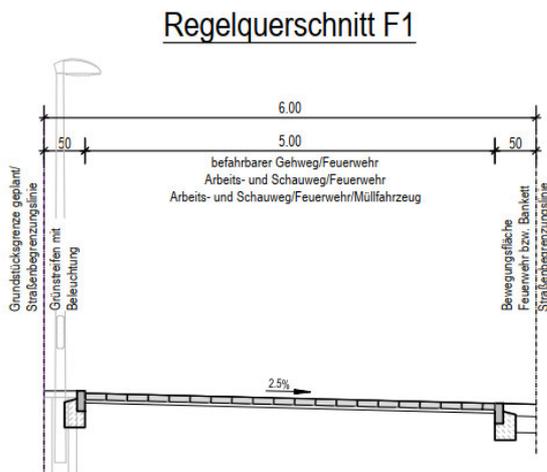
Arbeits- und Schauweg mit Feuerwehraufstell- und -bewegungsfläche mit Befahrung durch Müllfahrzeuge (Kurvenbereich)
